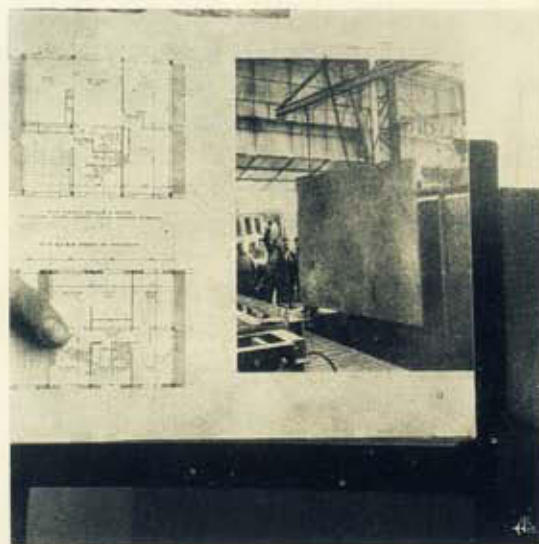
Elevação e transporte de outro elemento para depósito ao ar livre.
